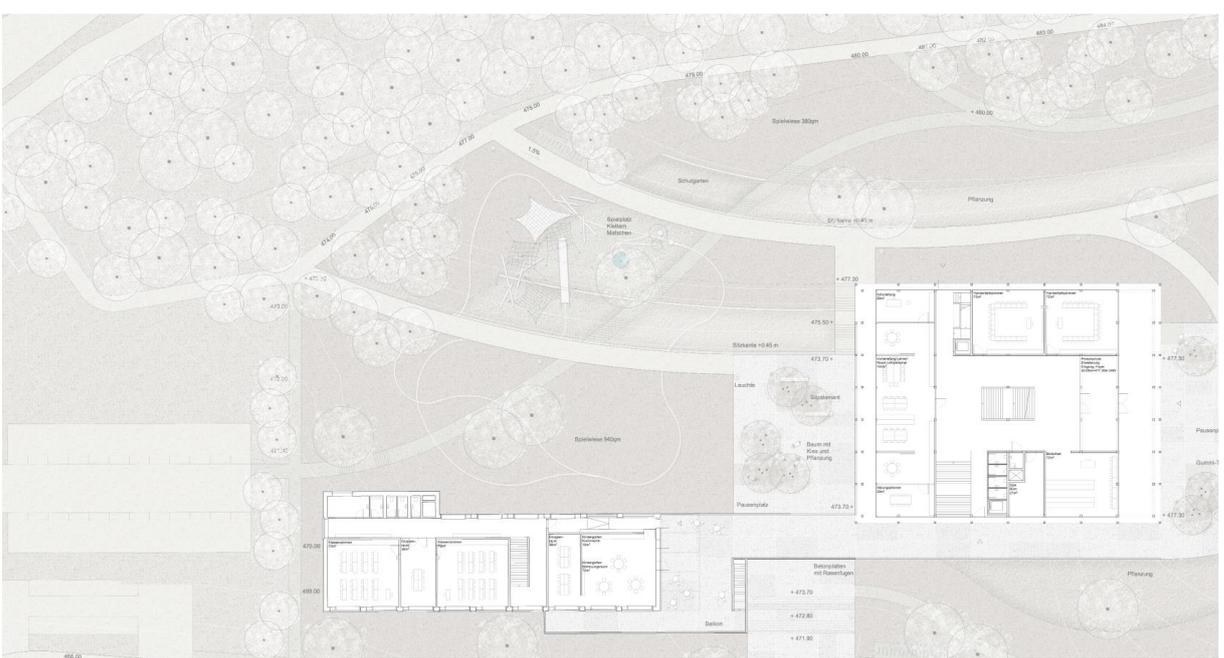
Grundriss Erdgeschoss Primarstufe
